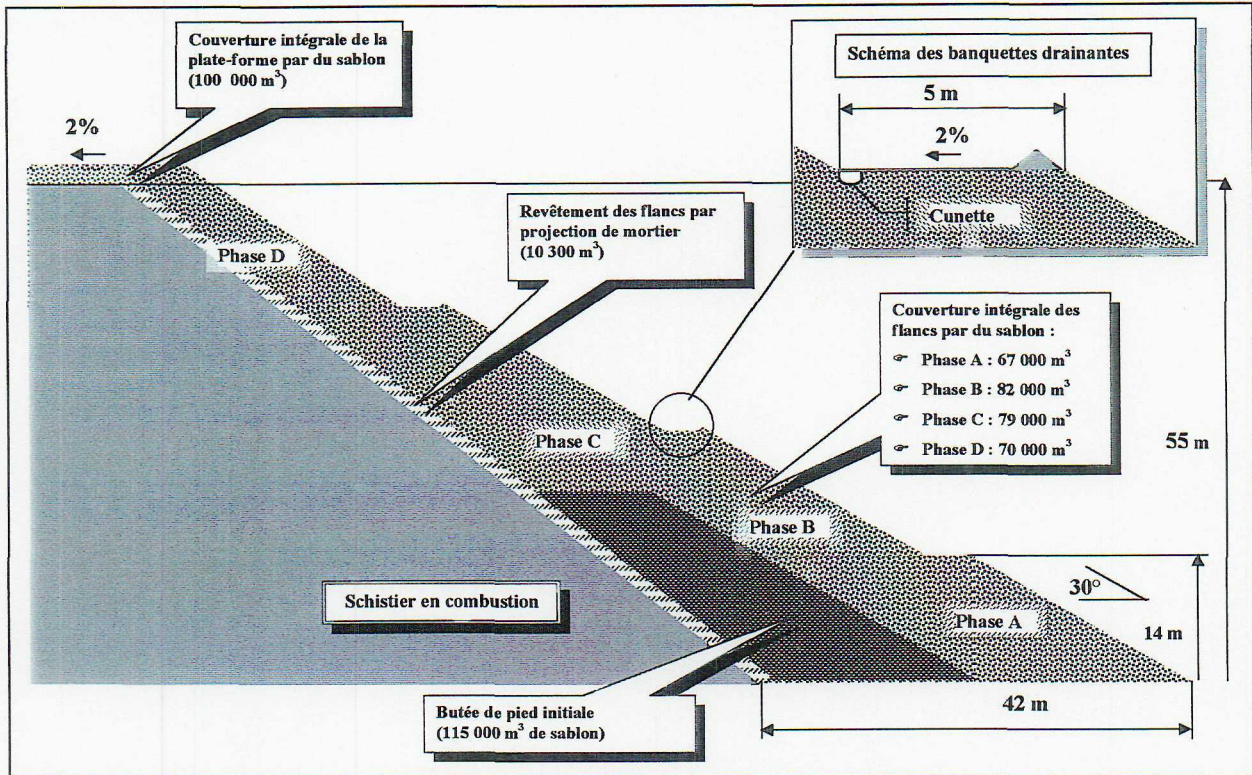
Coupe type des travaux de confinement du schistier Simon.
